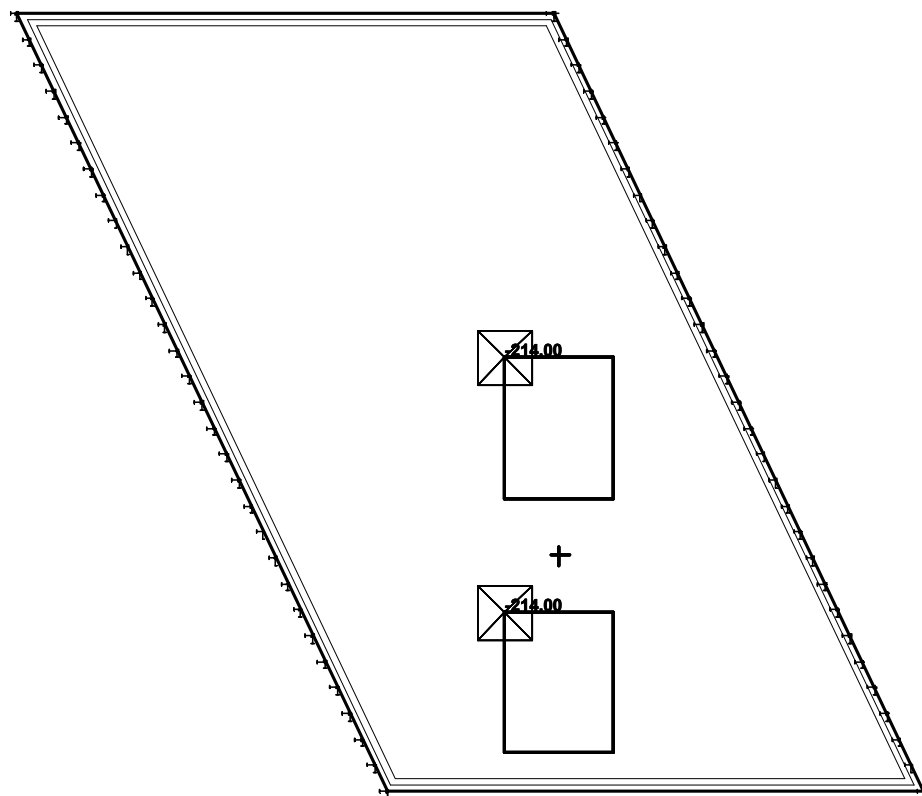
Schéma zatížení konstrukce dopravou, vč. roznášení kolových tlaků LM1, poloha pro stanovení maxima ve středu konstrukce
